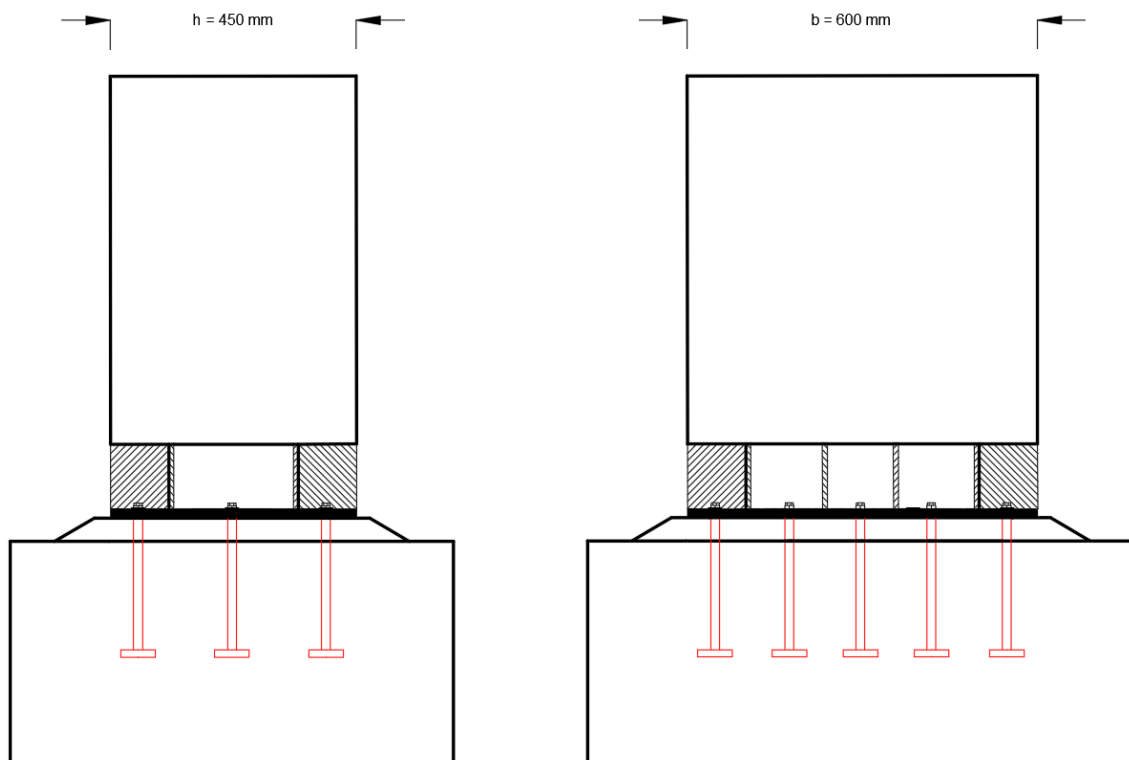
Vista en alzado y perfil de la disposición de cartelas y conectores P53 - P56
